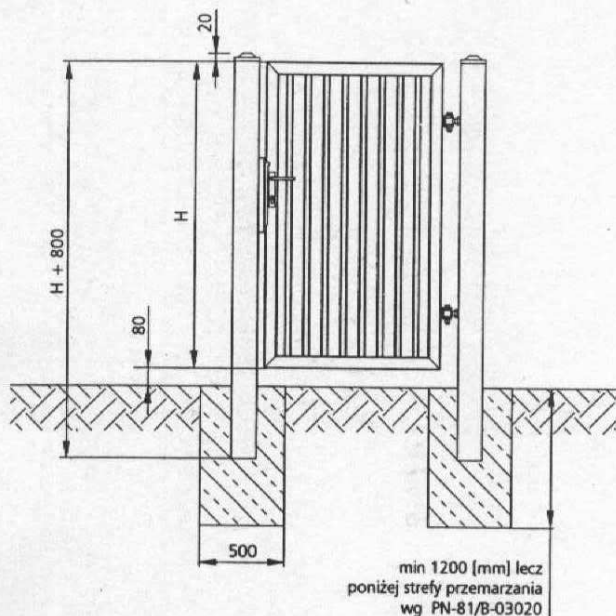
Montaż przy użyciu płytek montażowych (do słupa stalowego lub betonowego).
